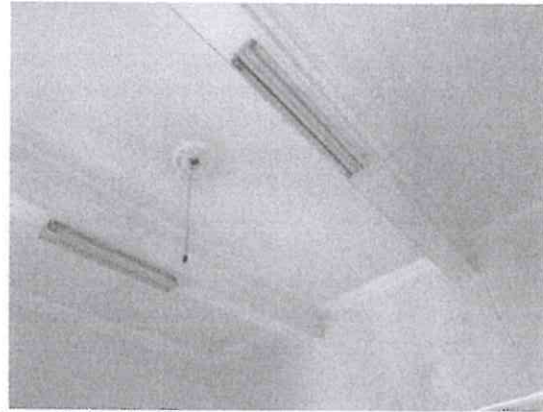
Muros, columnas y losa del pasillo, sin afectaciones estructurales.
